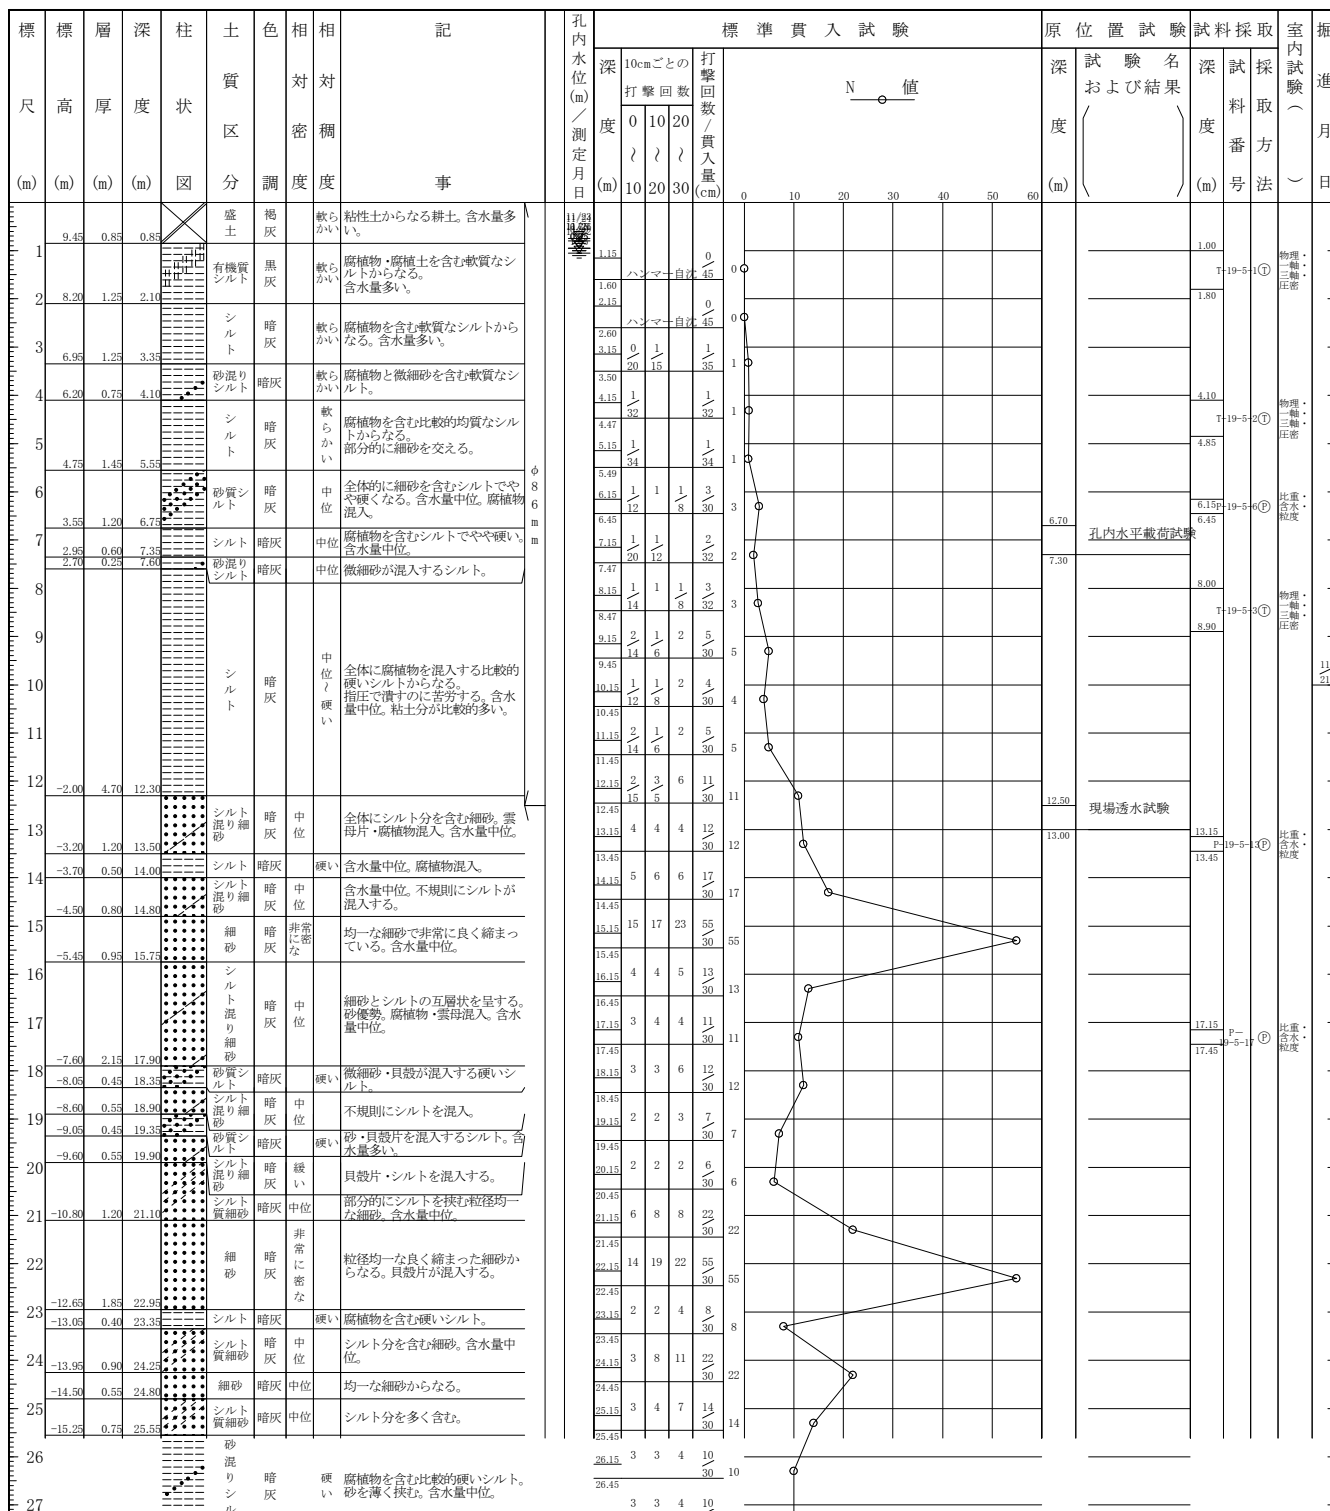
(2) ボーリング柱状図 (No.5-2)
